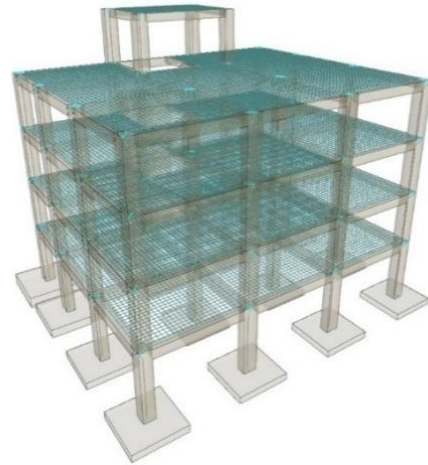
Vista tridimensional de las zapatas Sistema Tradicional
